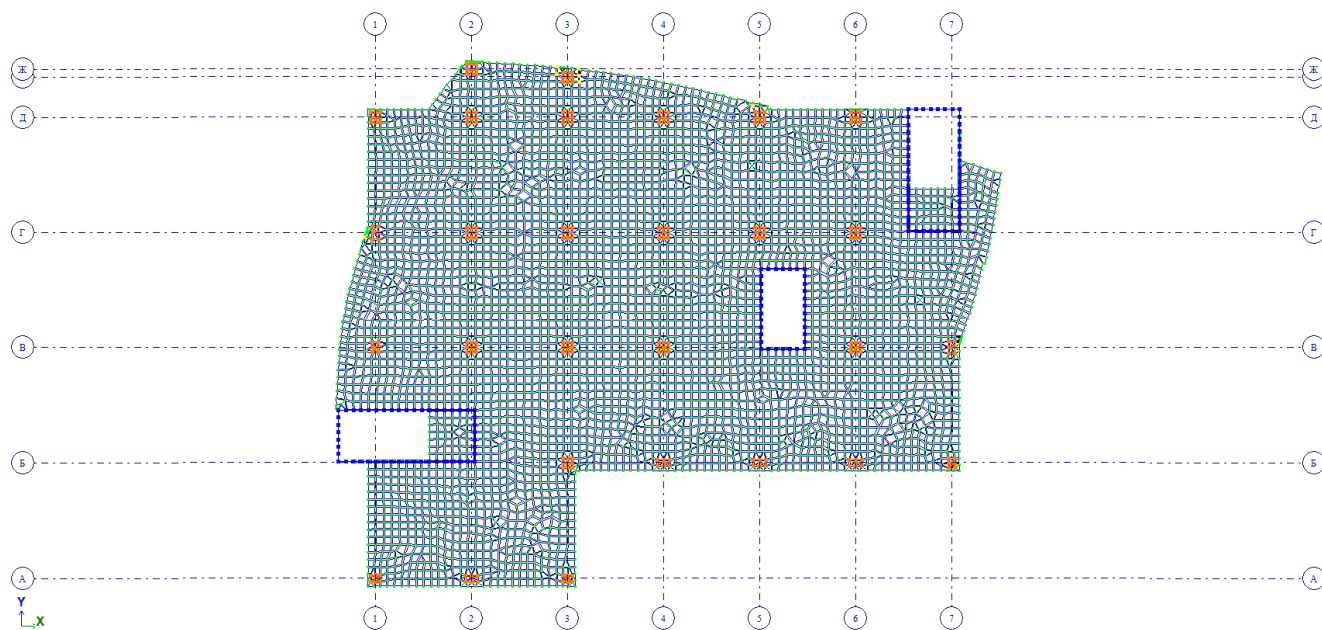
Схема разбивки плиты перекрытия на конечные элементы.
